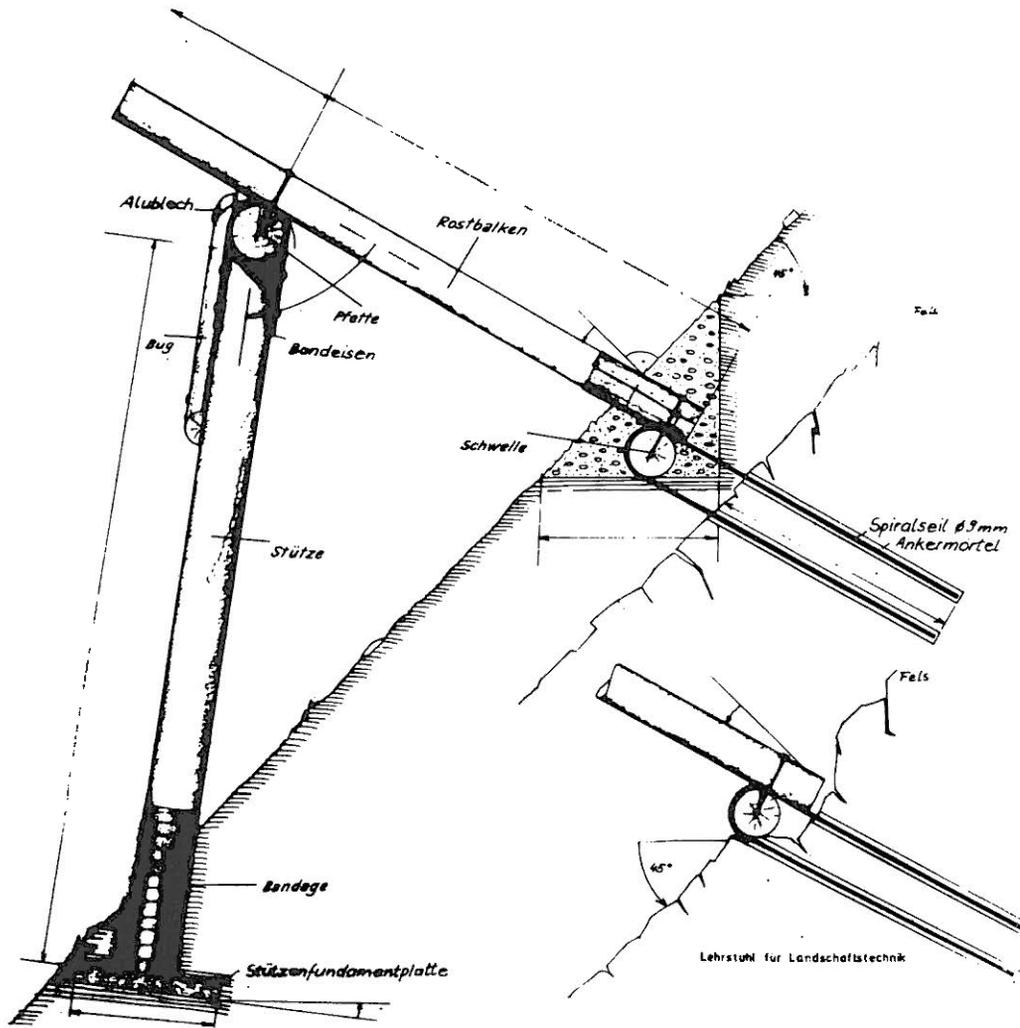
Bauplan: Schneerechen aus Rundholz/Randwerk (EISLF).
